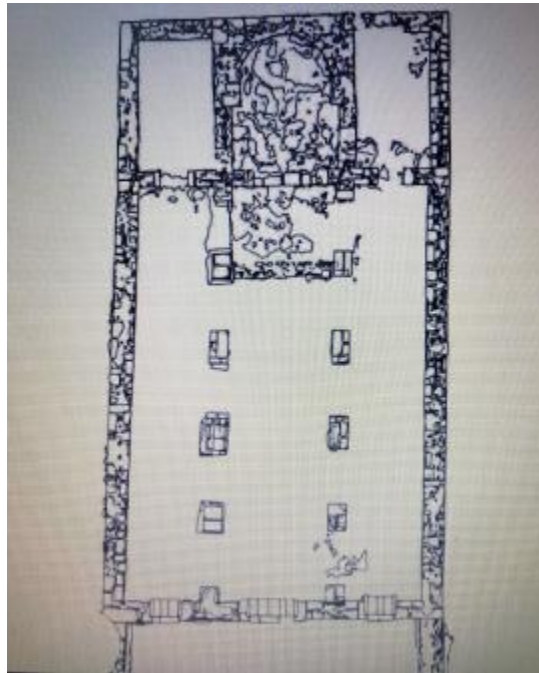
Planta de la Basílica de Son Bou, Menorca, siglo V.
